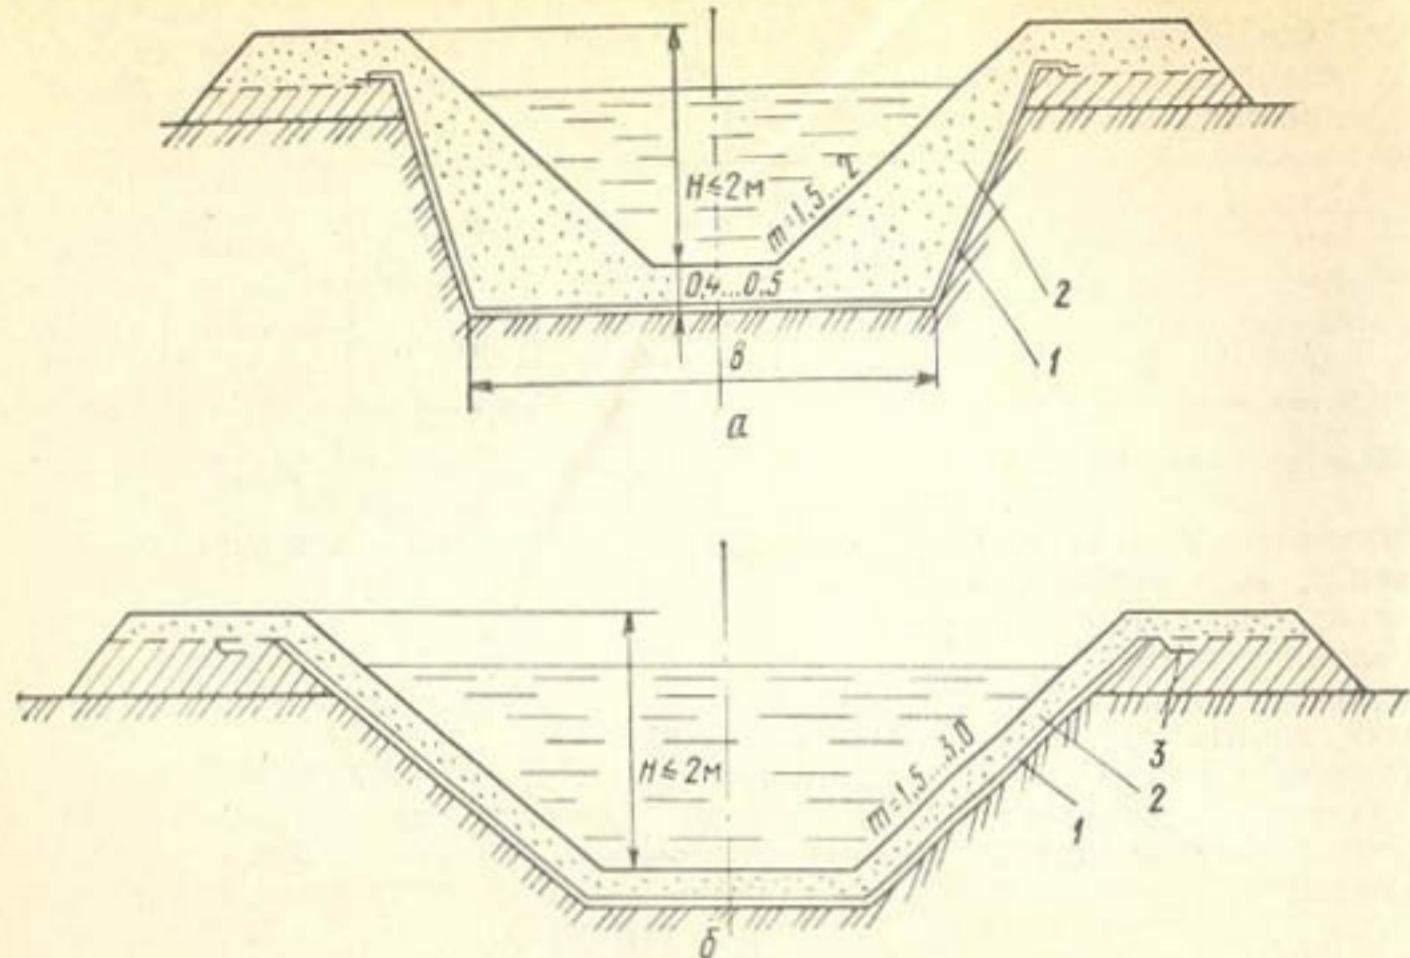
Схемы укладки грунтопленочной облицовки на канале:
